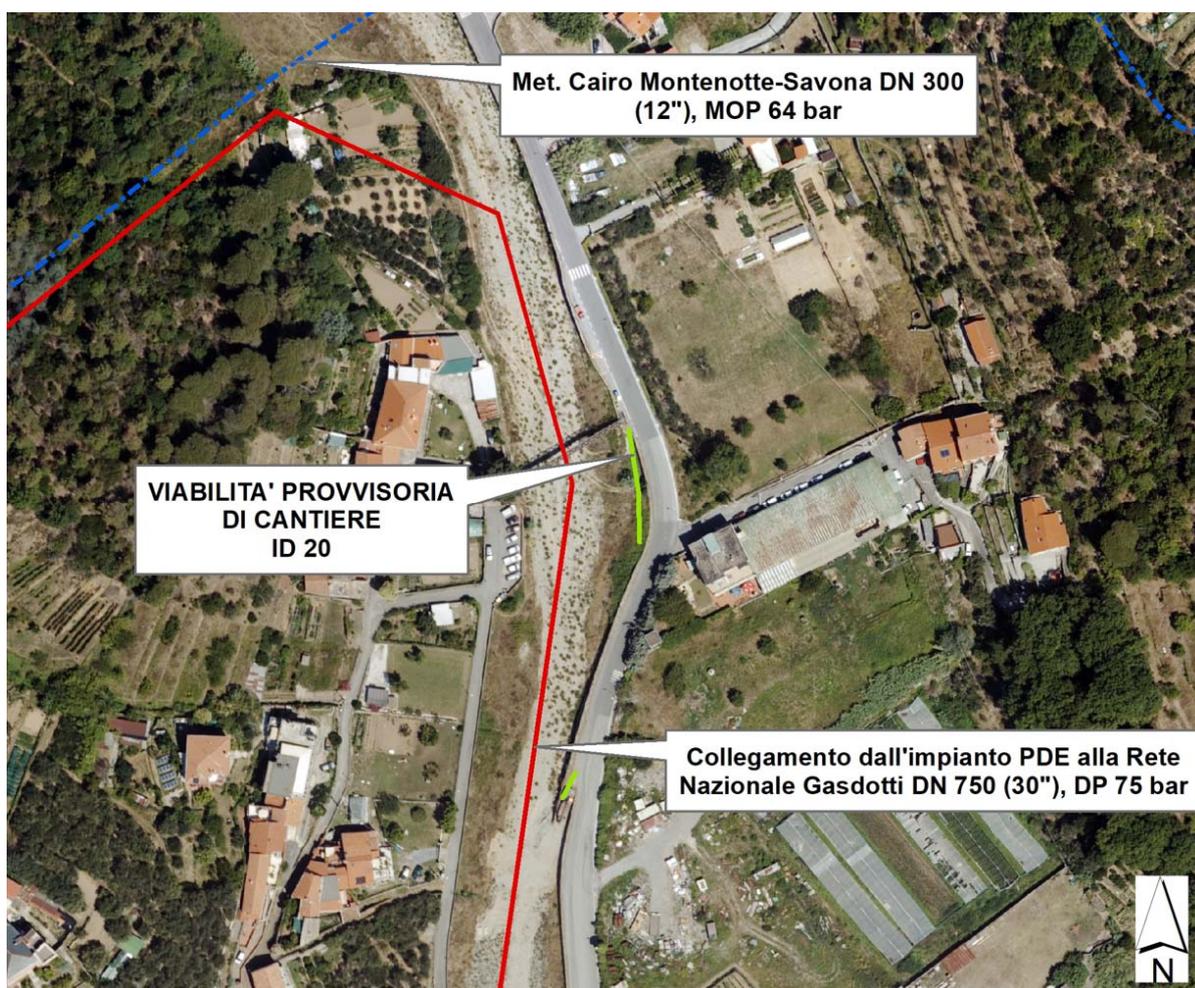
Planimetria di inquadramento della strada provvisoria di cantiere ID20
